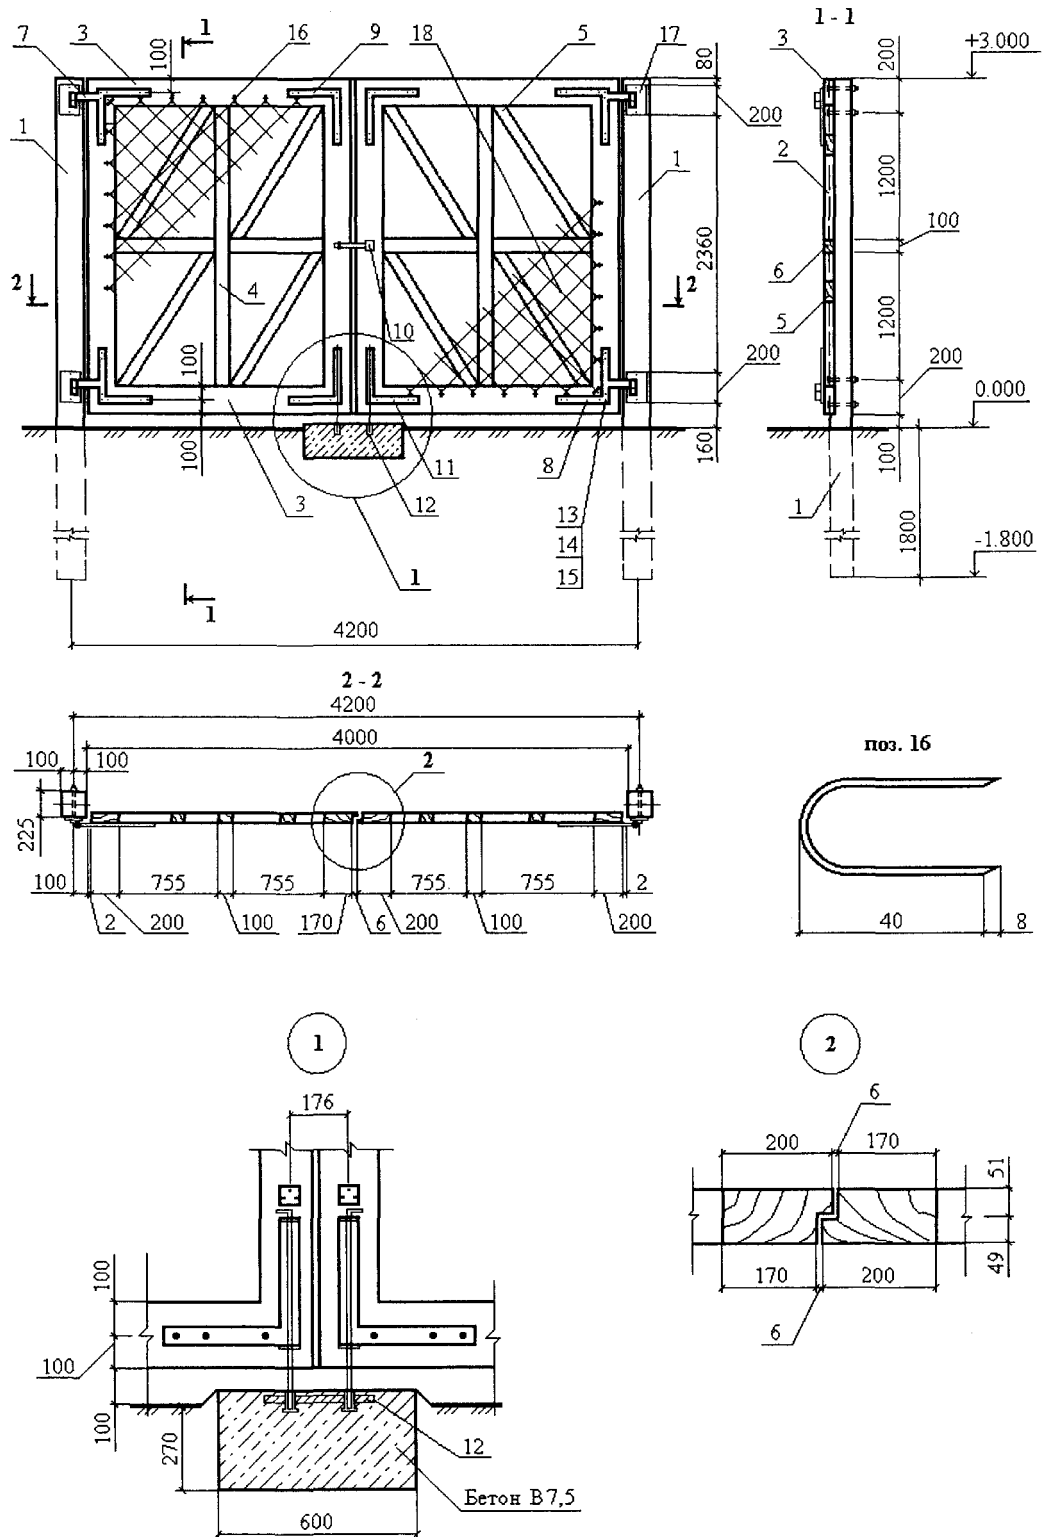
Ворота сетчатые 4,2x3,0 м на железобетонных стойках
